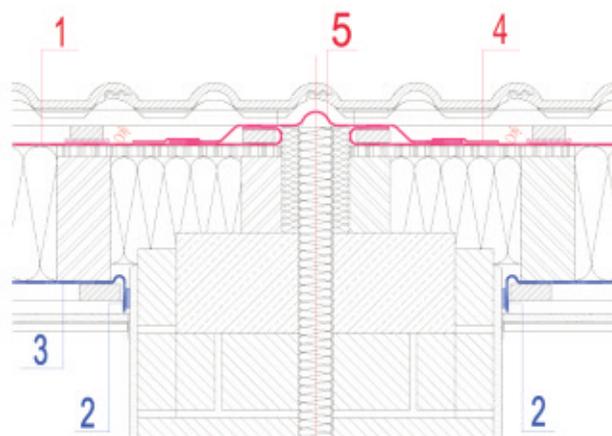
Устройство подкровельной изоляции на пожарной стенке
